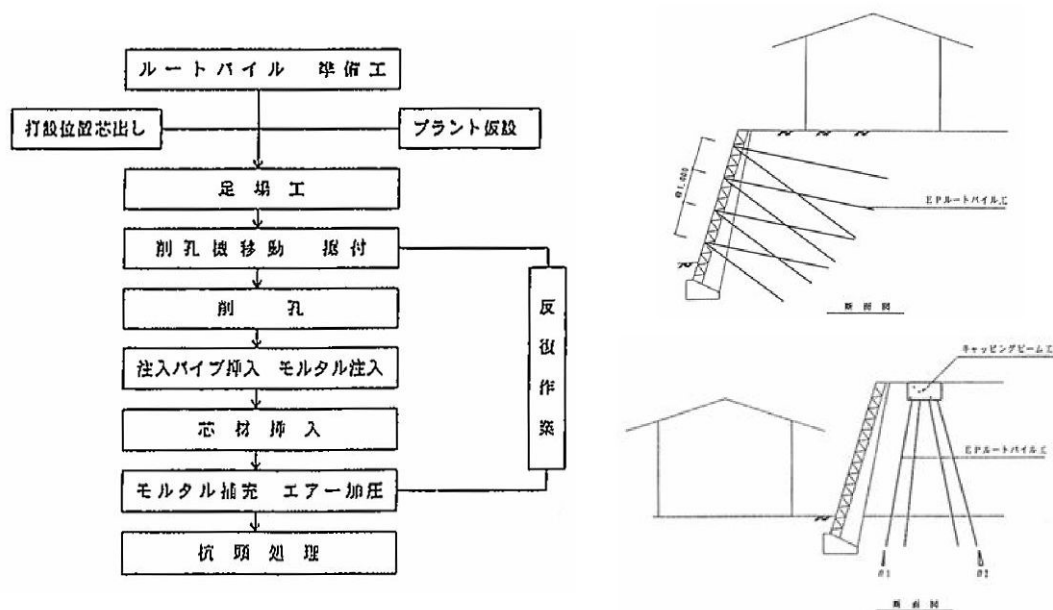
ルートパイル工の施工法・施工手順⁹⁾
